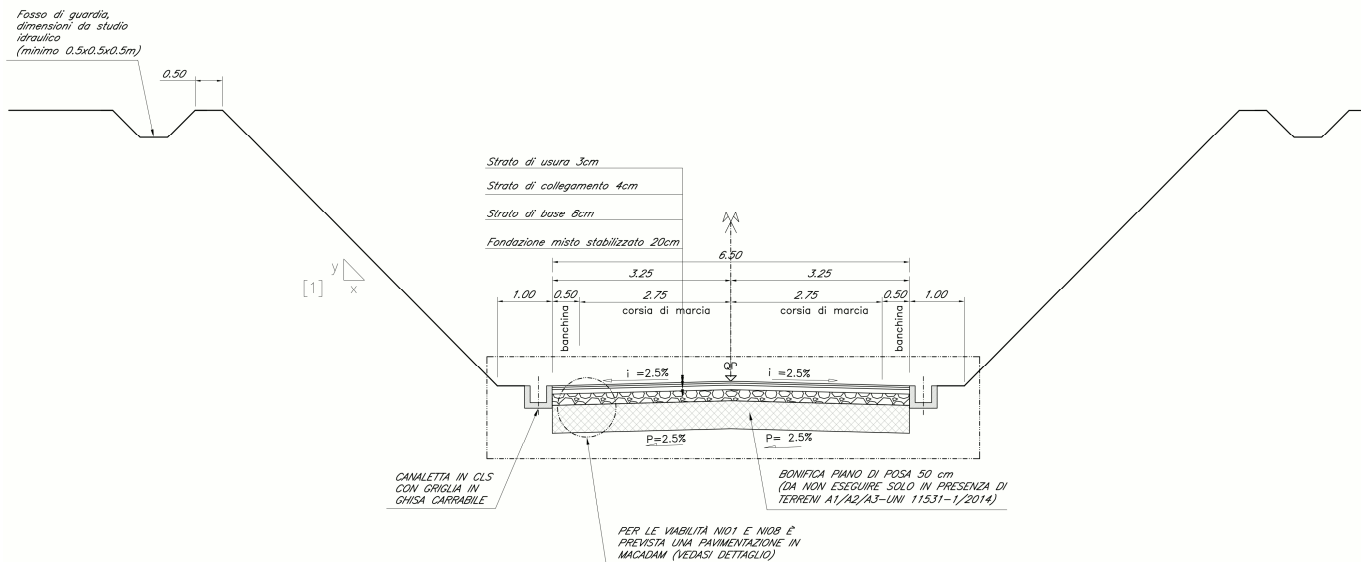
Viabilità secondarie. Sezione tipo in trincea con pavimentazione bituminosa
